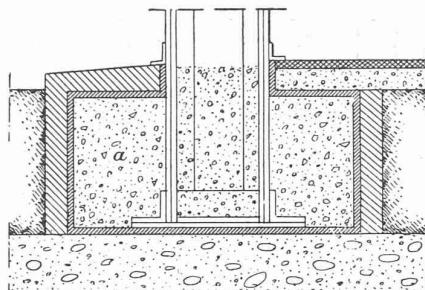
Isolation des poteaux principaux d'un bâtiment.
